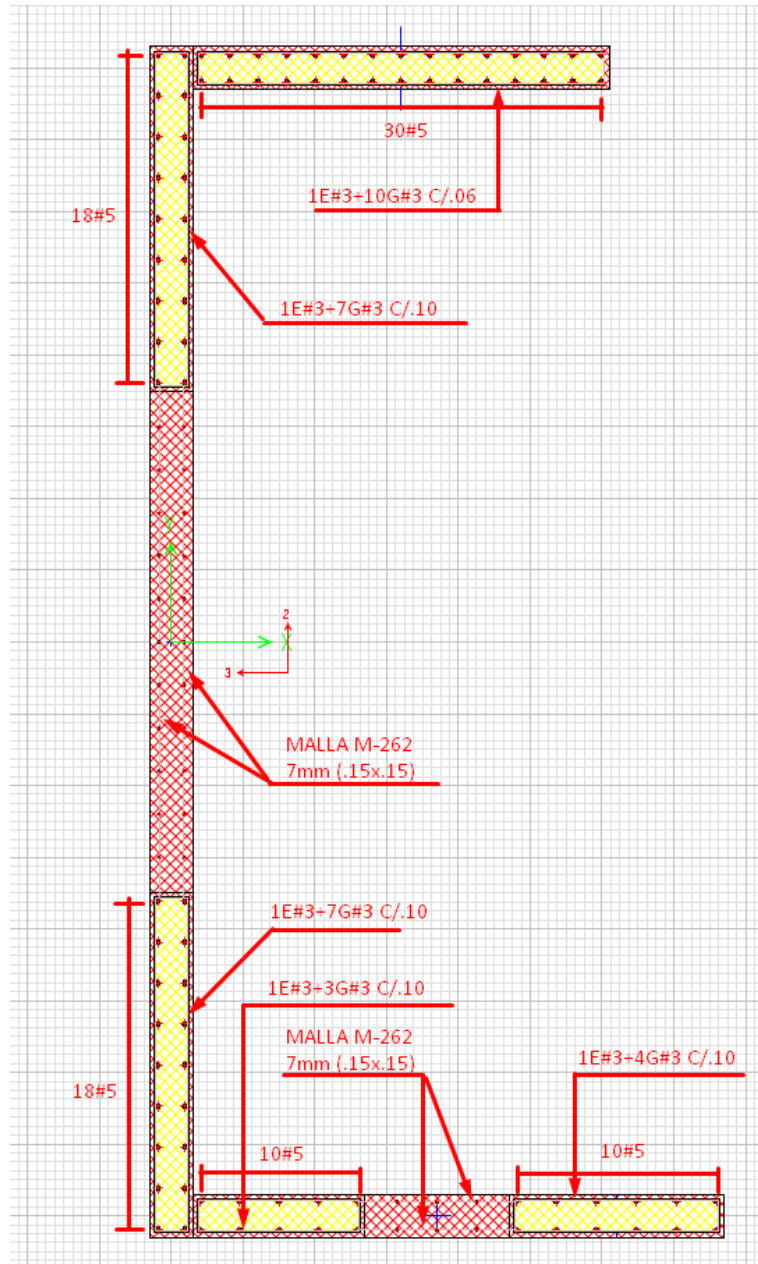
Configuración del refuerzo muro M-2. Fuente: Elaboración propia.
